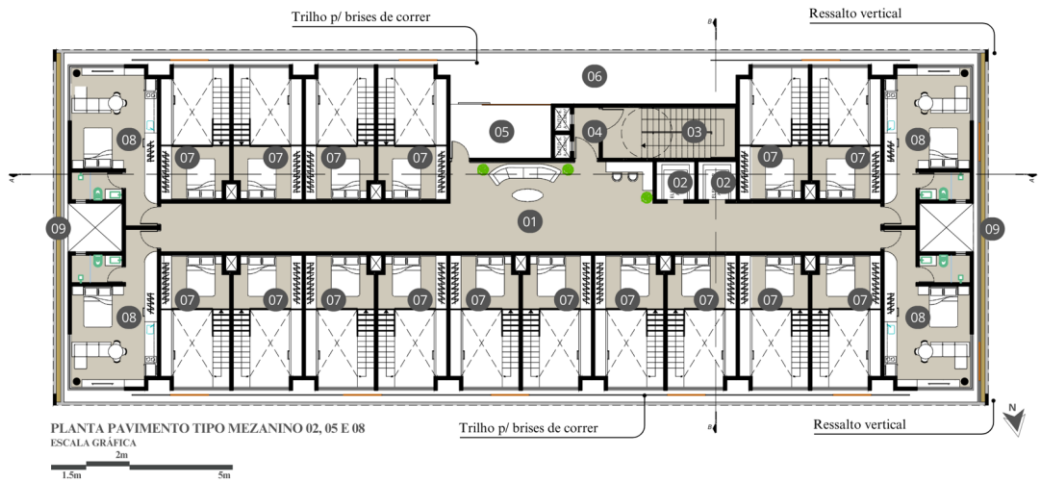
Planta baixa pavimento tipo 02, 05 e 08.
